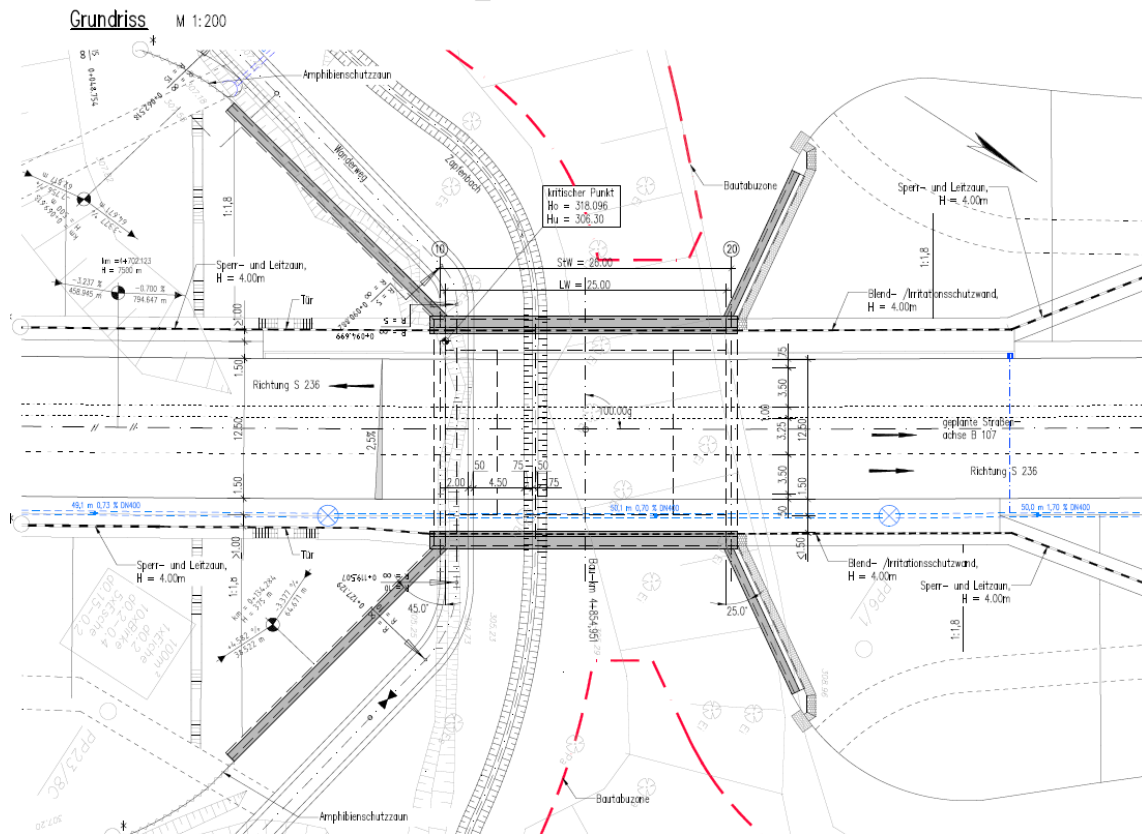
Grundriss Bauwerk 1-071 (Planung OBERMEYER 2017)
